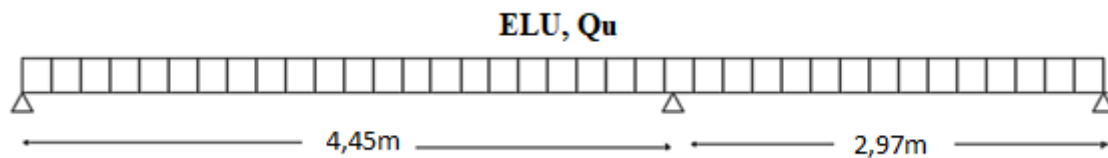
Schéma statique de la poutrelle à 2 travées.
